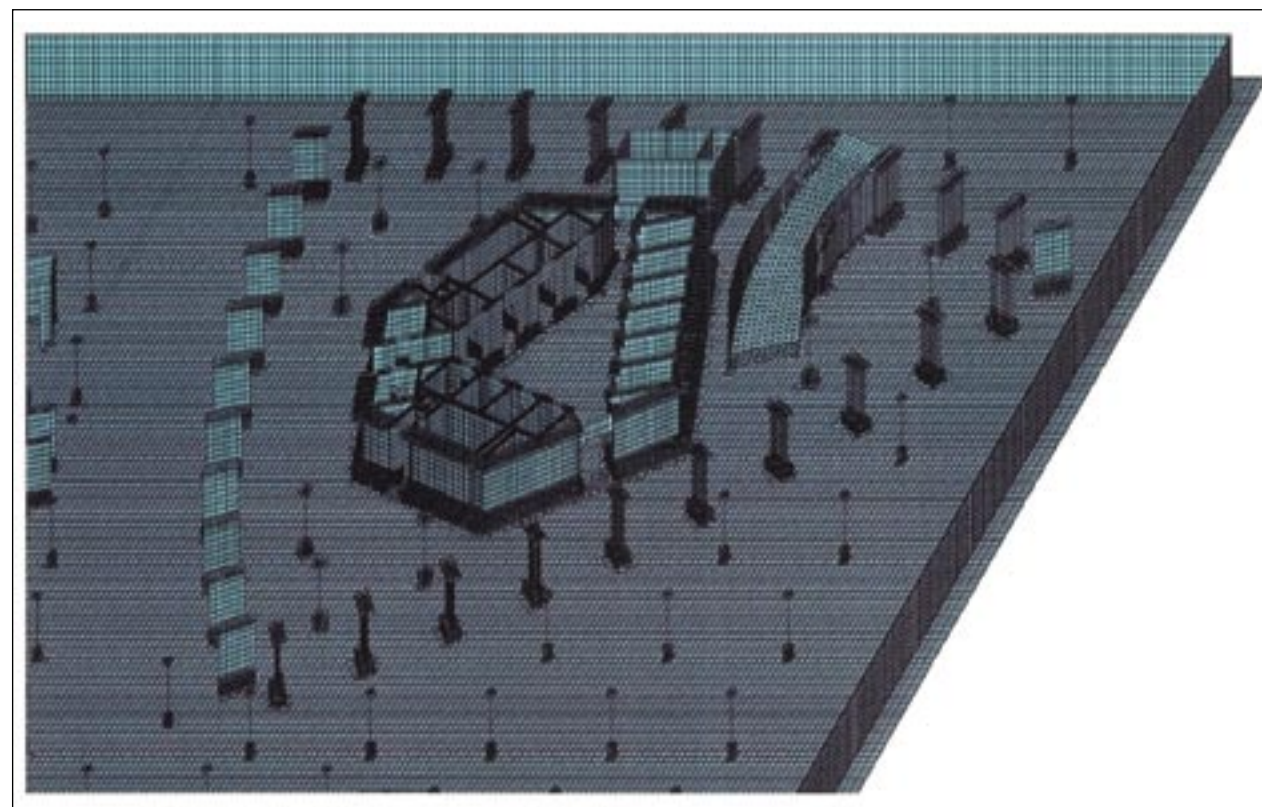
Схема моделирования узлов соединения стен и колонн с фундаментной плитой
